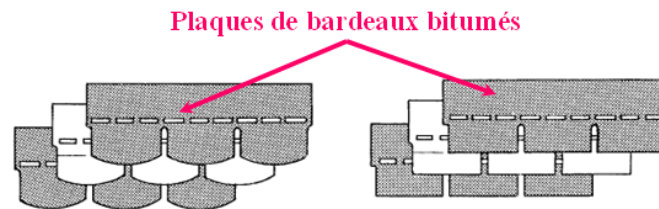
Disposition des bardeaux bitumineux sur une toiture (DTU 40.14)
